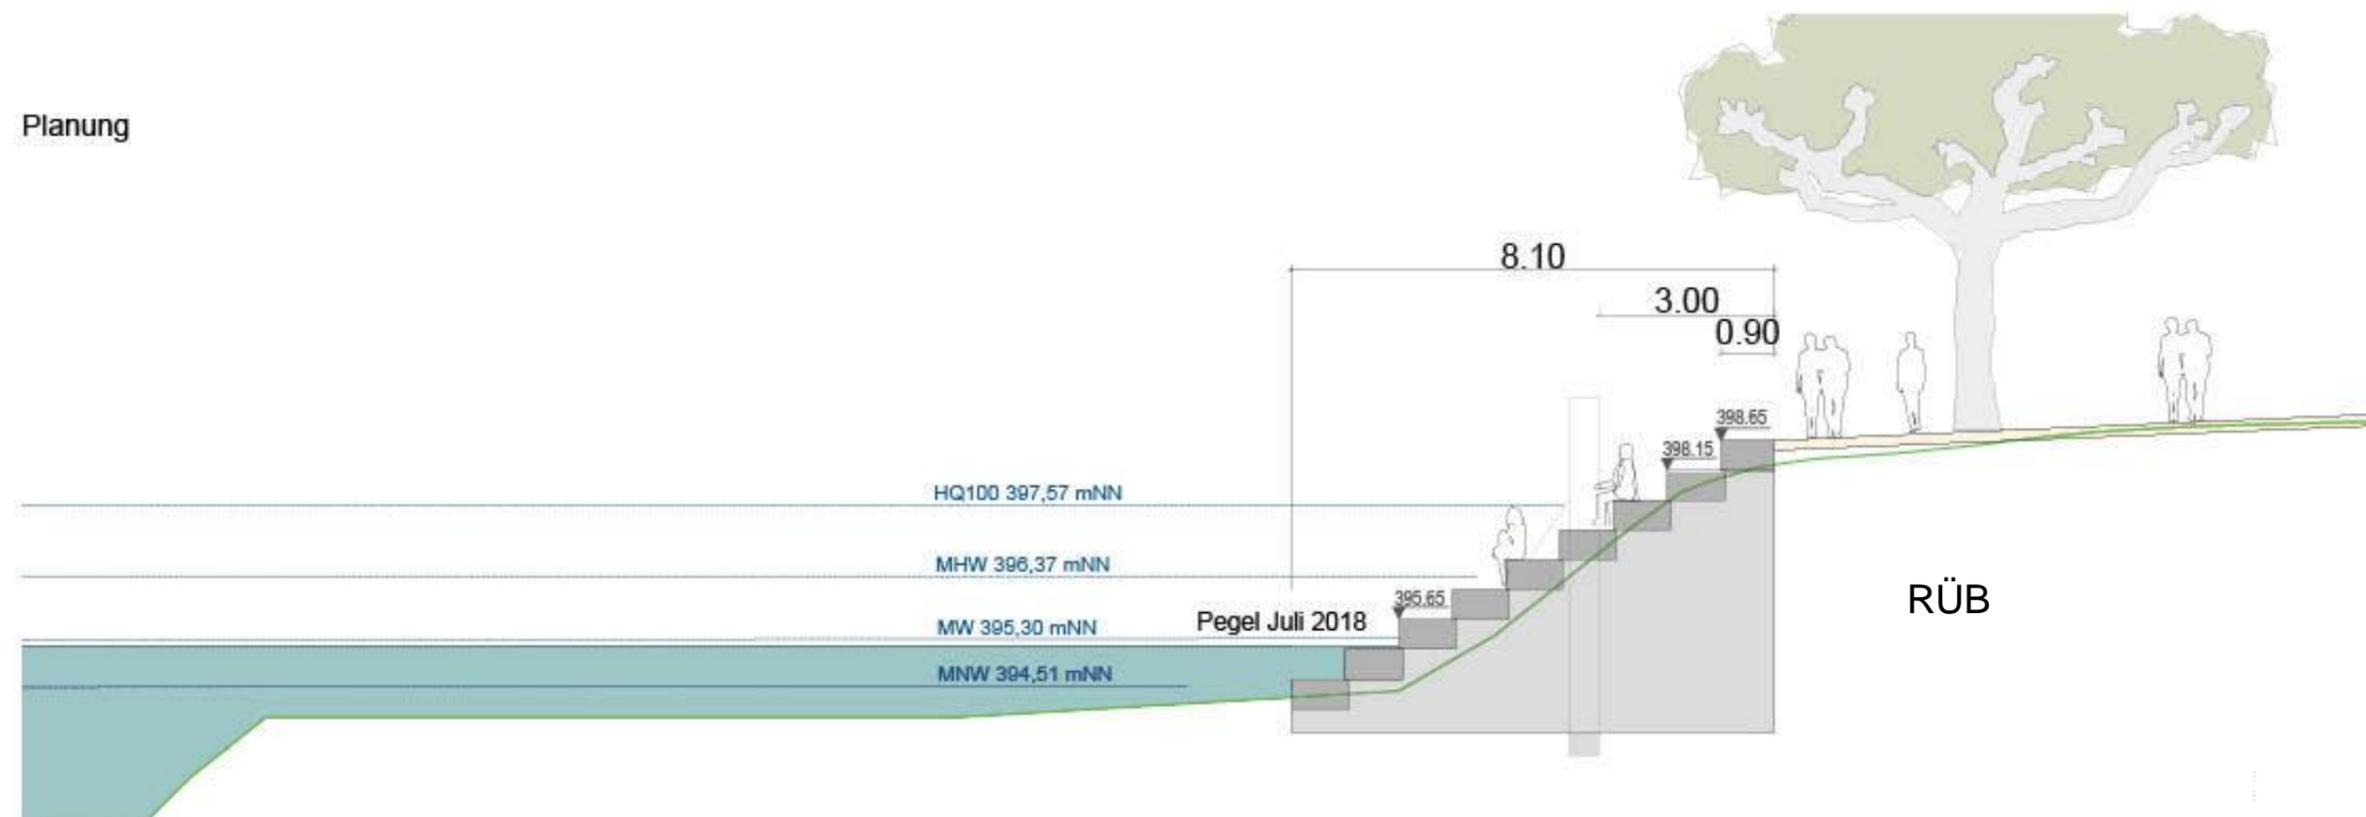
Sitzstufen am Bismarckplatz (Schnitte | Planstatt Senner)
